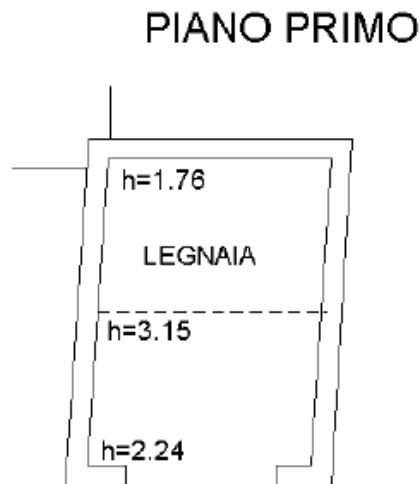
Estratto della planimetria catastale – p.lla 1949 p.p.
